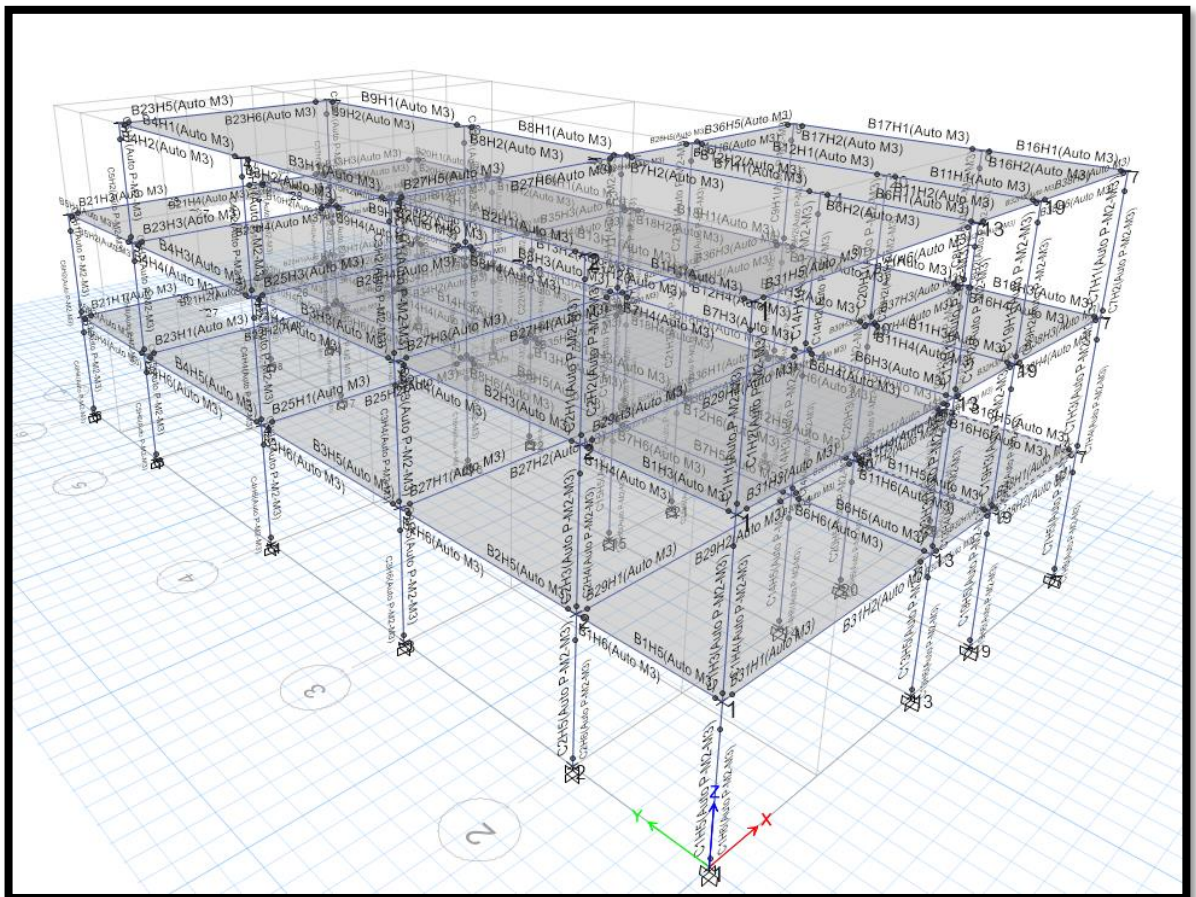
rotulas plásticas en columnas y vigas Módulo I.
